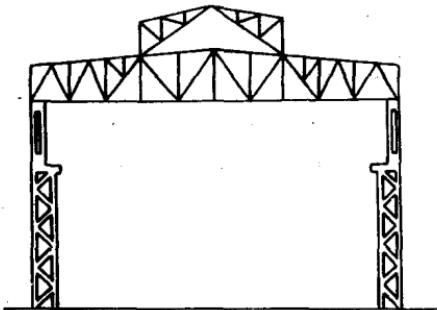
钢屋架和钢筋混凝土柱组成的排架结构
